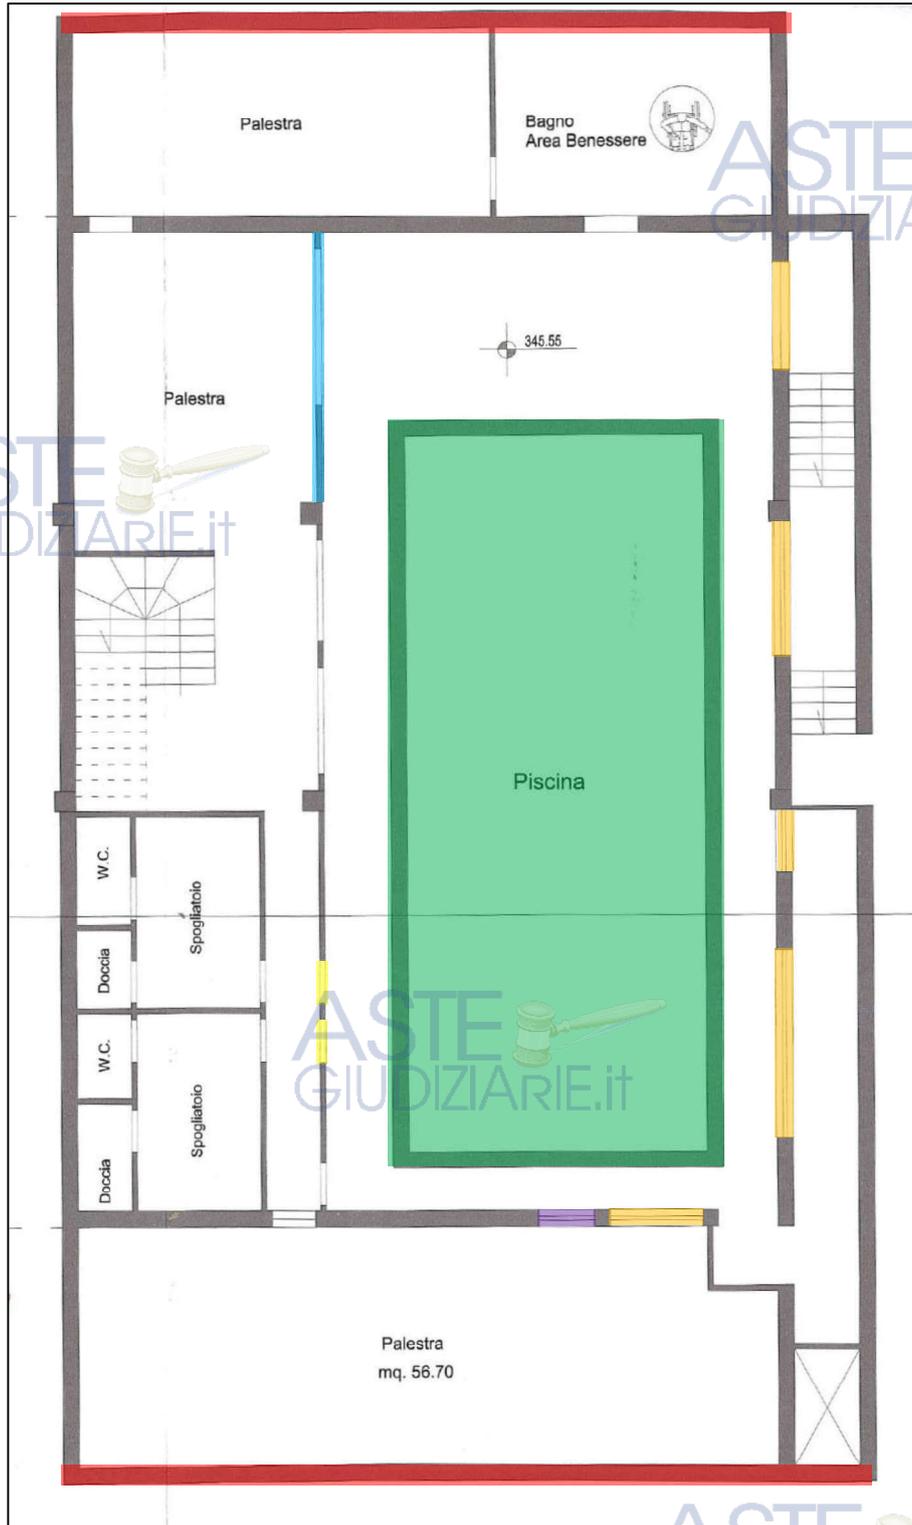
Planimetria stato di progetto con evidenziati gli elementi che sono stati poi realizzati in difformità da quanto approvato
